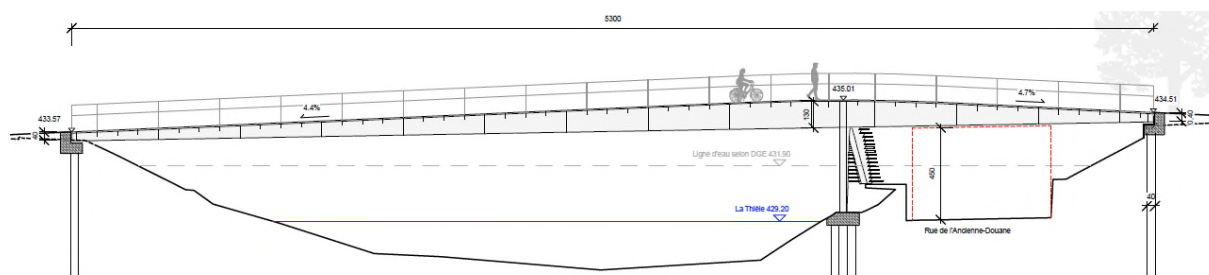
Coupe longitudinale de l'ouvrage avec mise en évidence des gabarits verticaux
